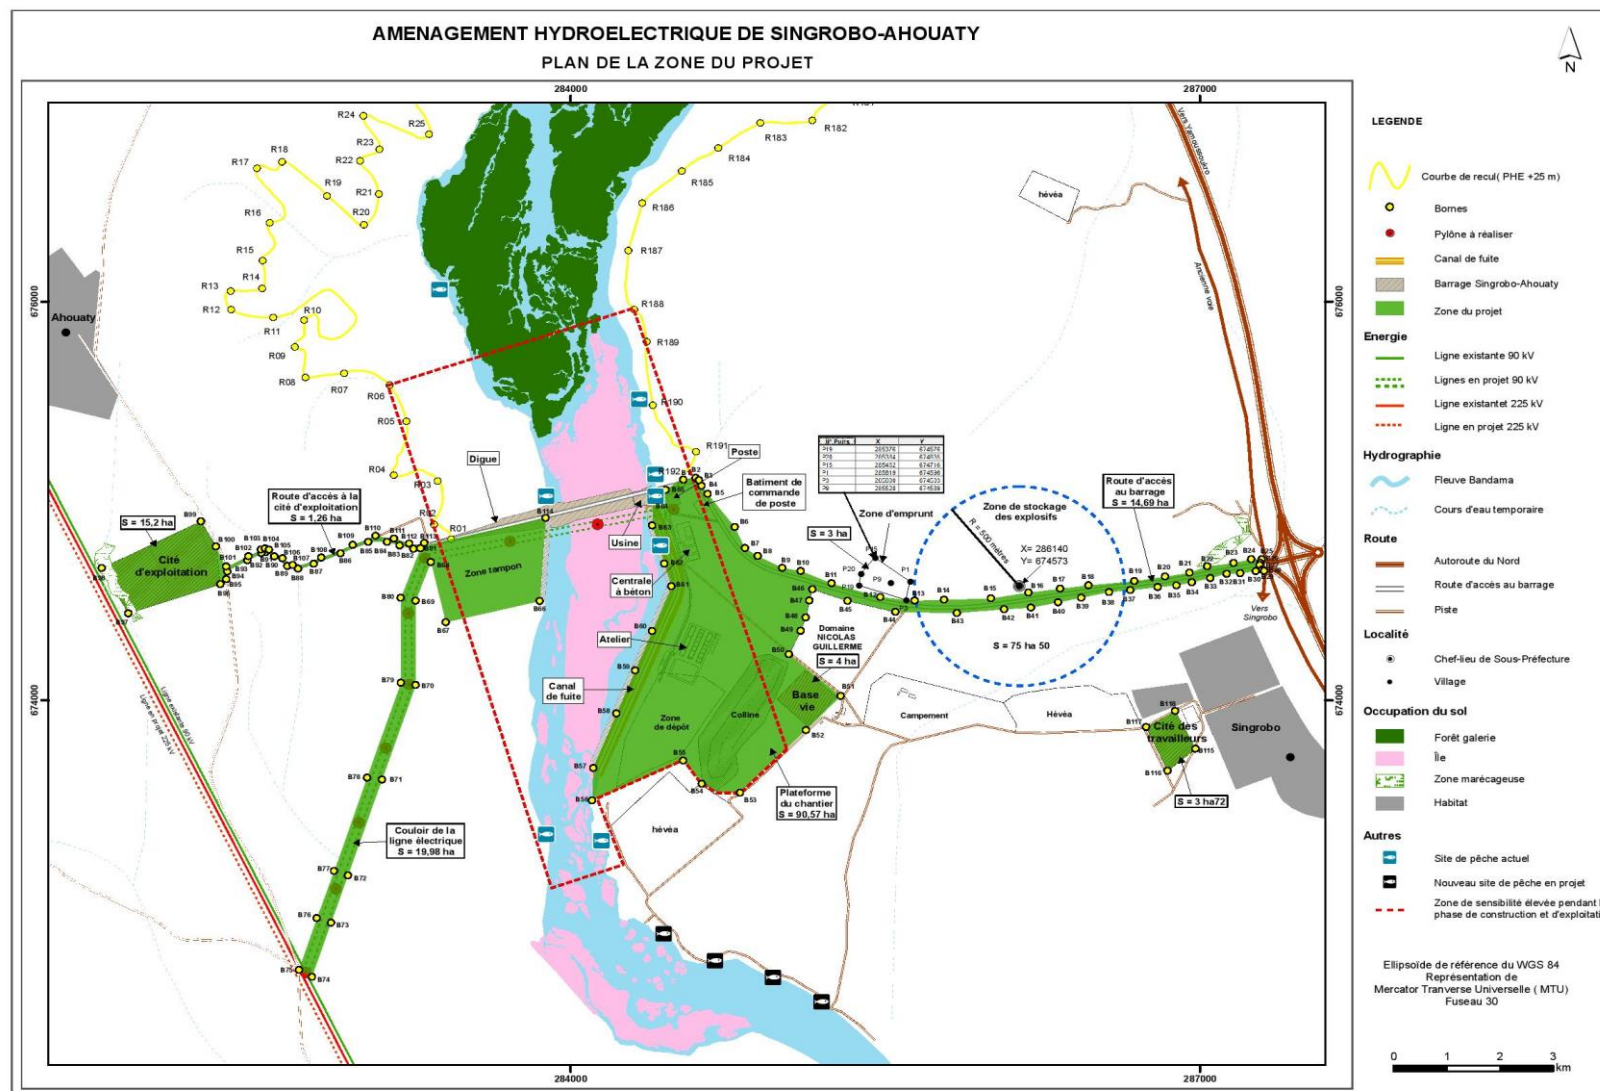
plan masse de la plateforme de chantier et emprises provisoires du chantier
